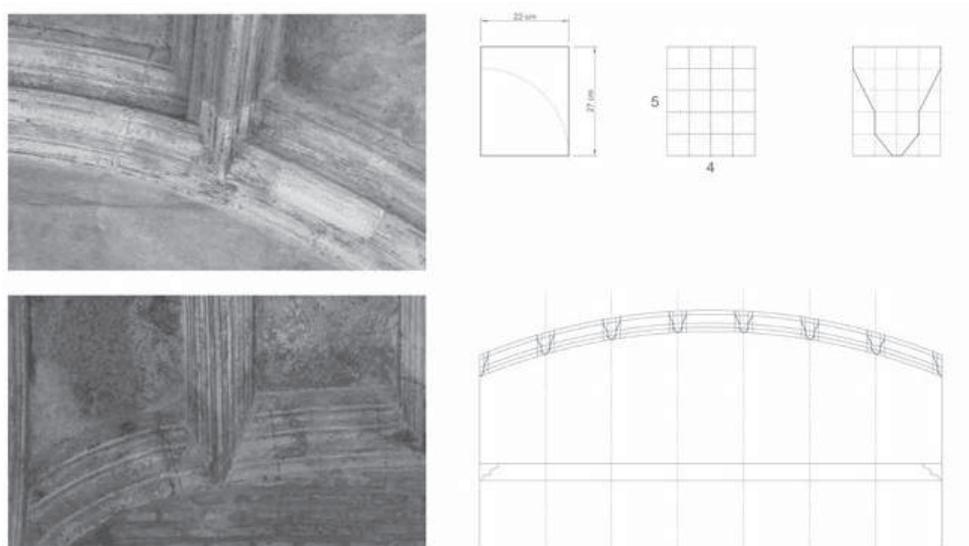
Geometría subyacente y construcción de los alzados de la antesacristía (planos del autor).
